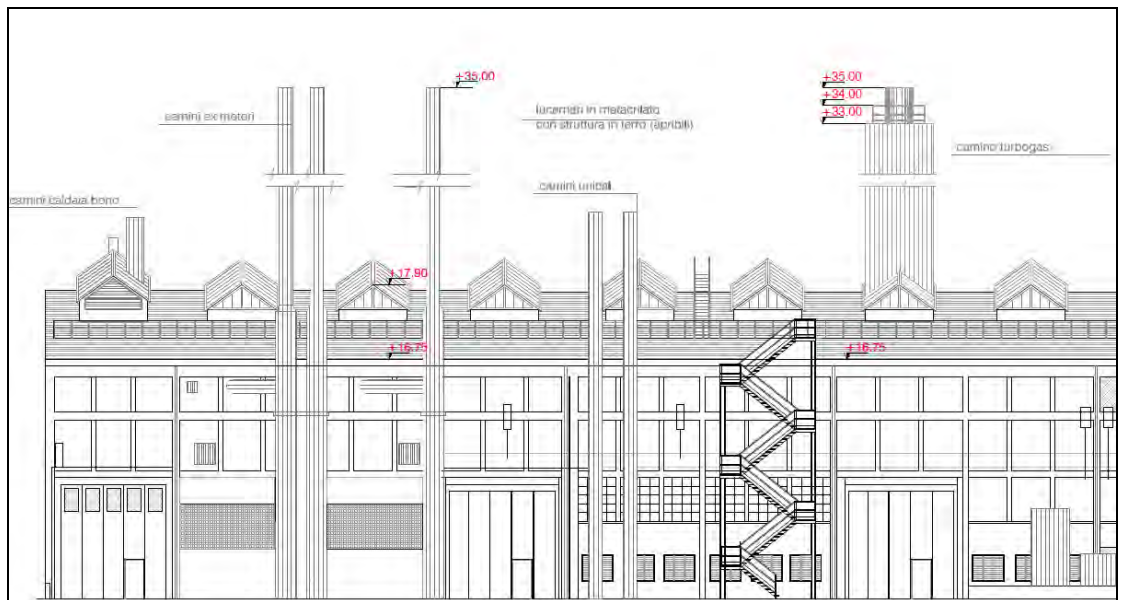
Estratto tav 01 – Prospetto est (particolare stato di fatto)
